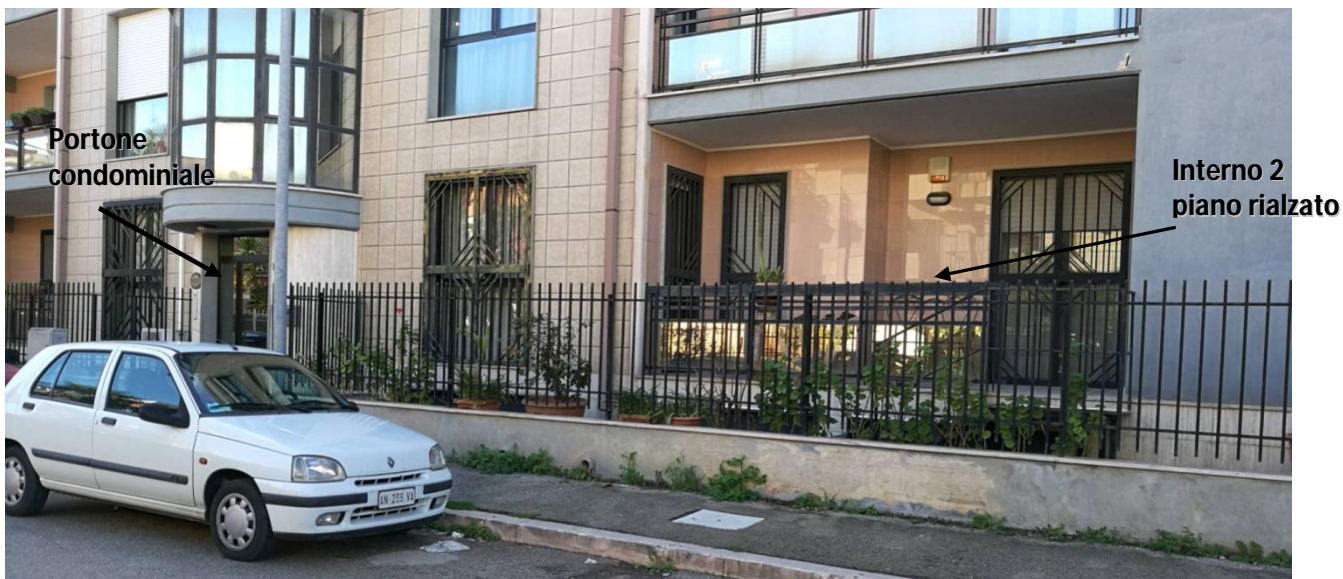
Vista del portone di accesso alla palazzina E (civ.12) e posizione dell'immobile
